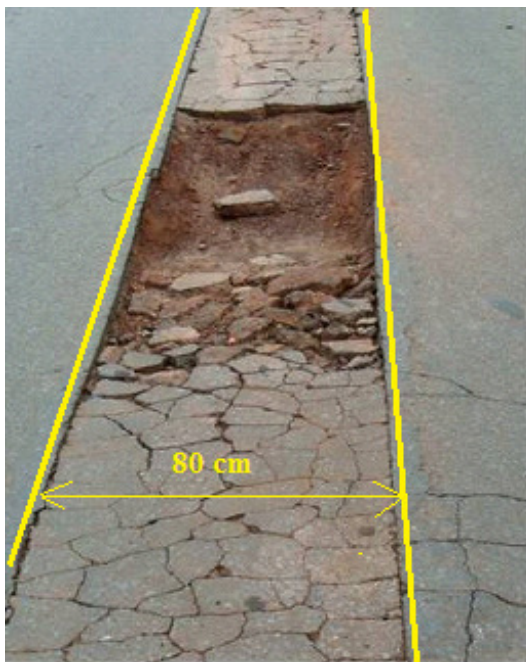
Deformação do pavimento com trincas e buraco.
